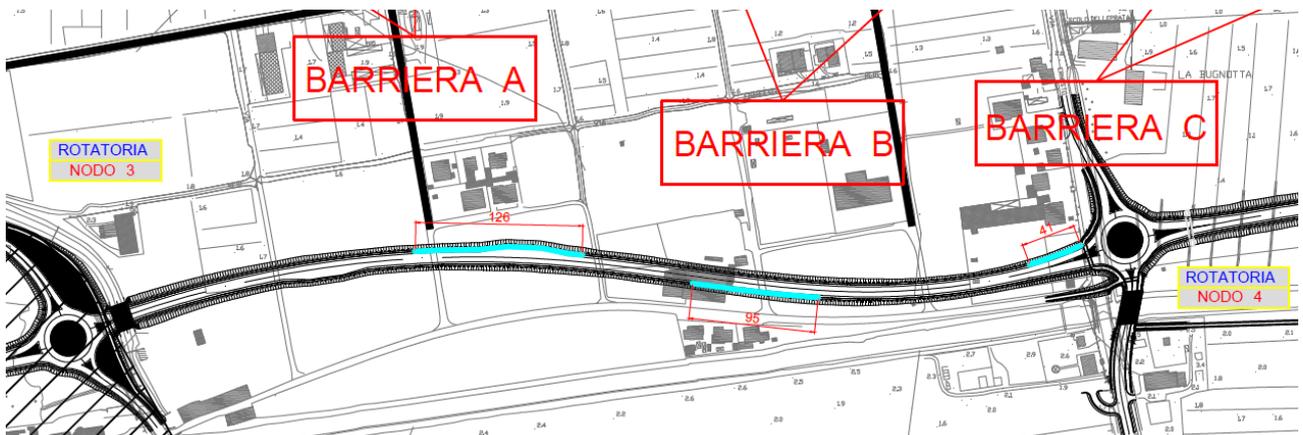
Planimetria barriere acustiche tratto 3-4 (lotto 3-5)
